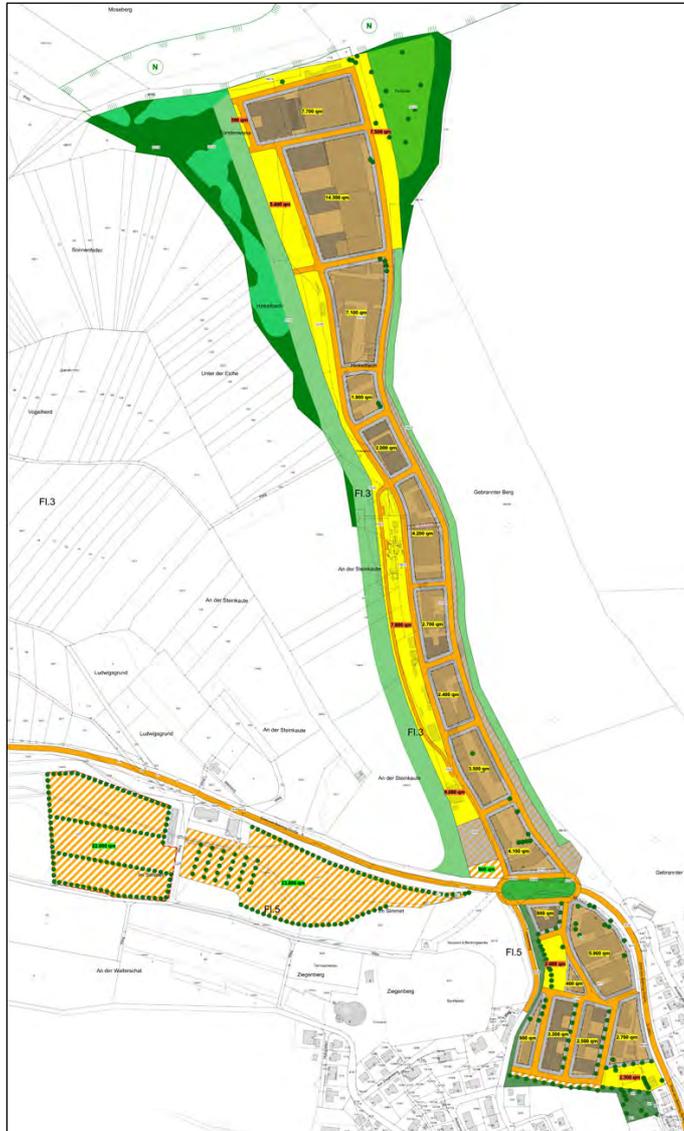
Site-Master-Plan, Teilbereich: Hauptwerk, Stand: Okt. 2006
